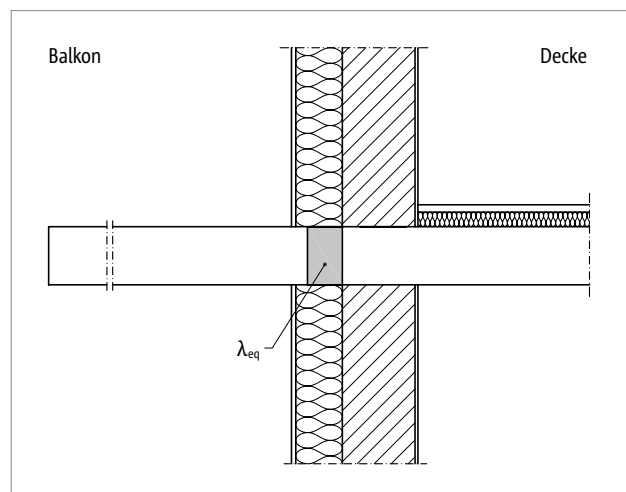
Darstellung einer Schnittzeichnung mit vereinfachtem Ersatzdämmkörper
